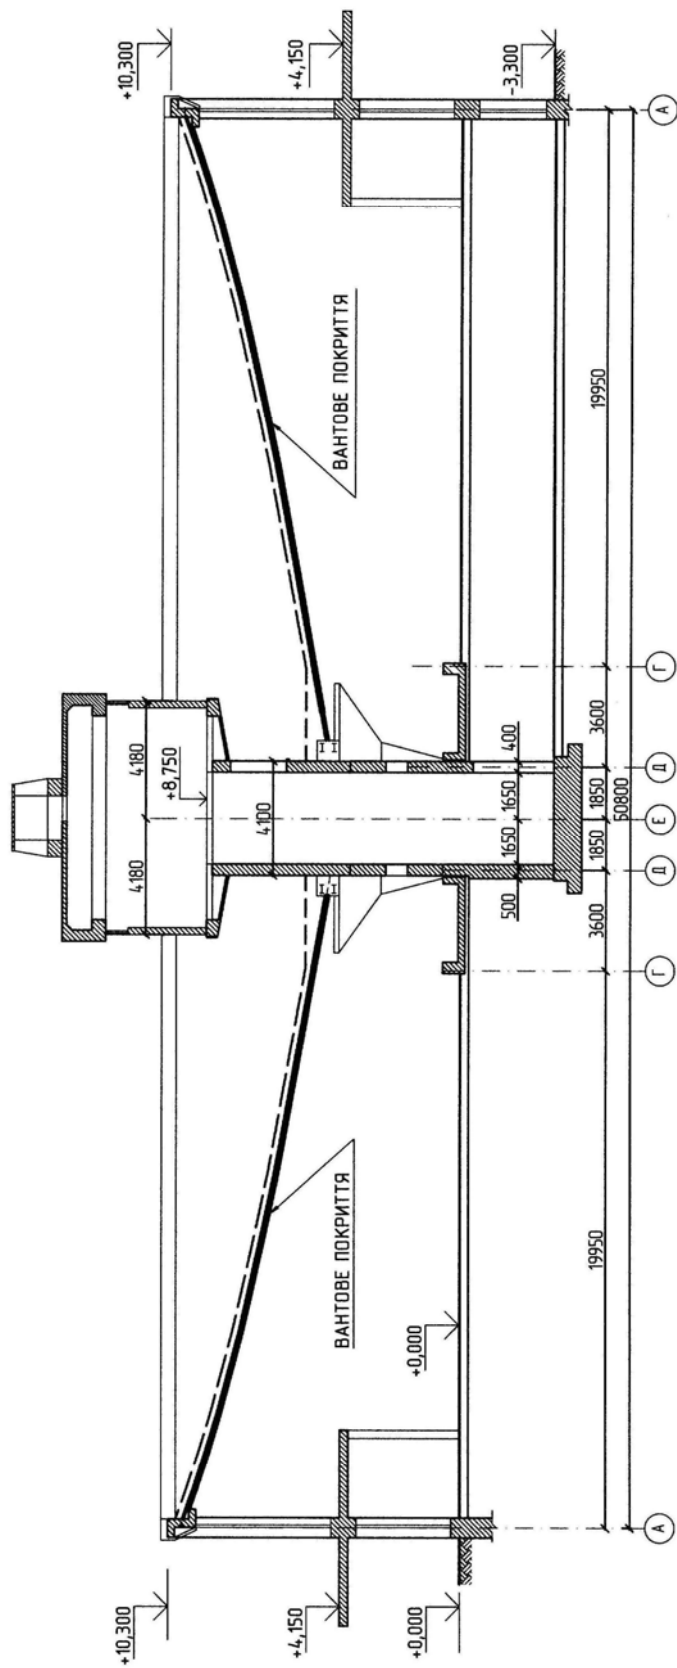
Поперечний переріз будівлі біовету мінеральних вод
